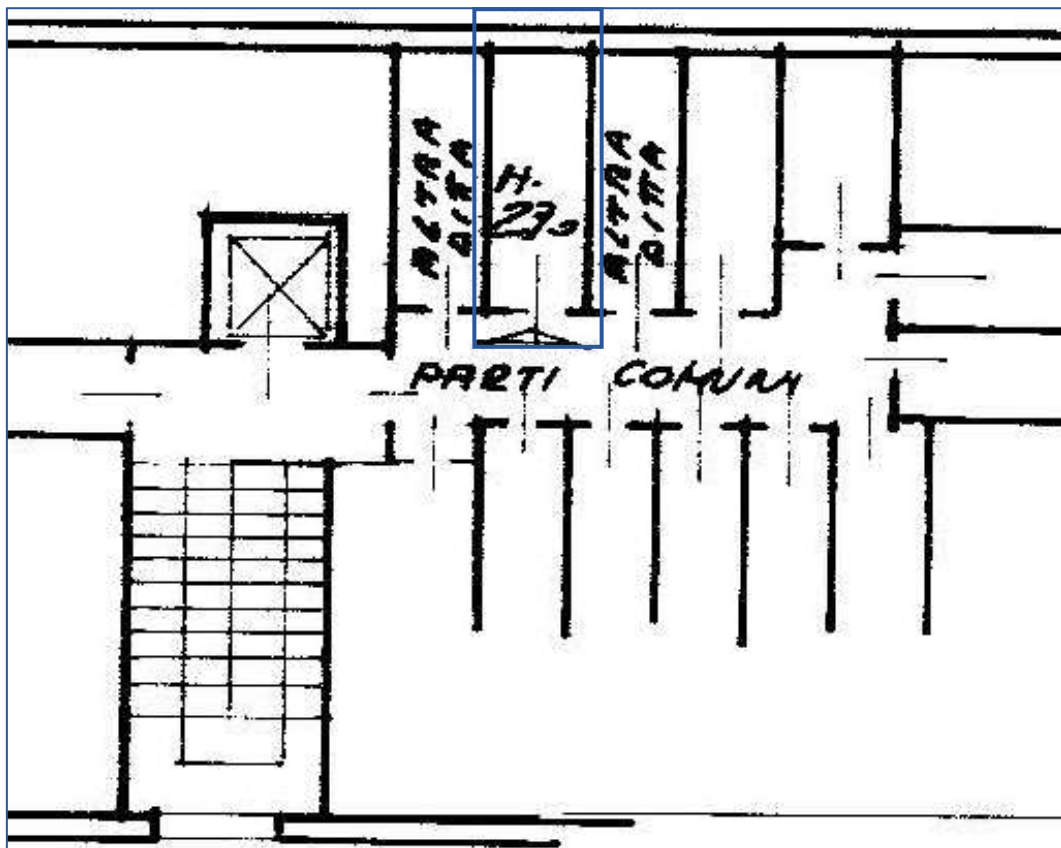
Estratto della planimetria catastale conforme allo stato di fatto rilevato - solaio
